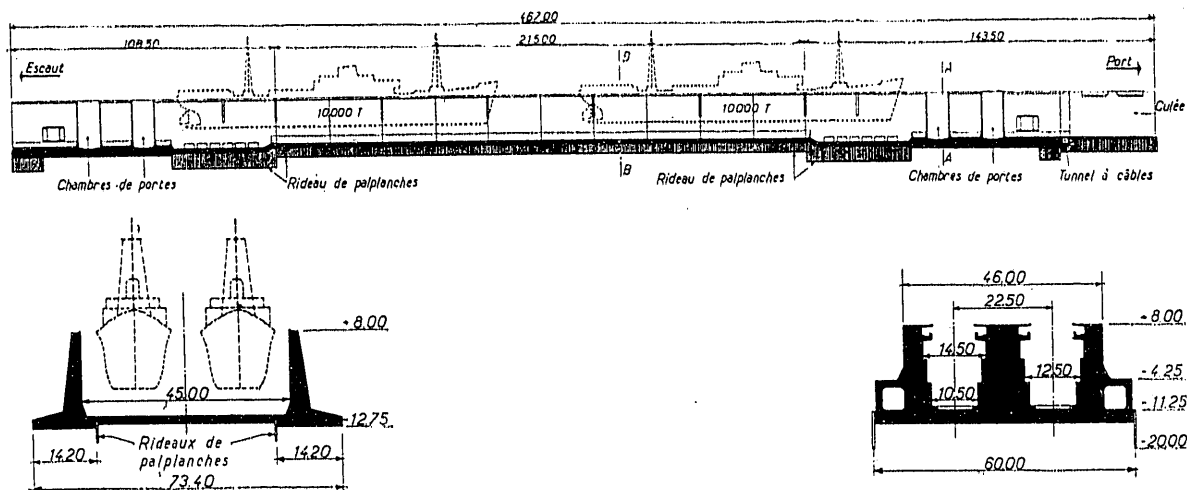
ª — Sección longitudinal, sección transversal en el cuenco (corte BB a la izquierda) y sección transversal en la cámara de compuertas (corte A-A, a la derecha).
